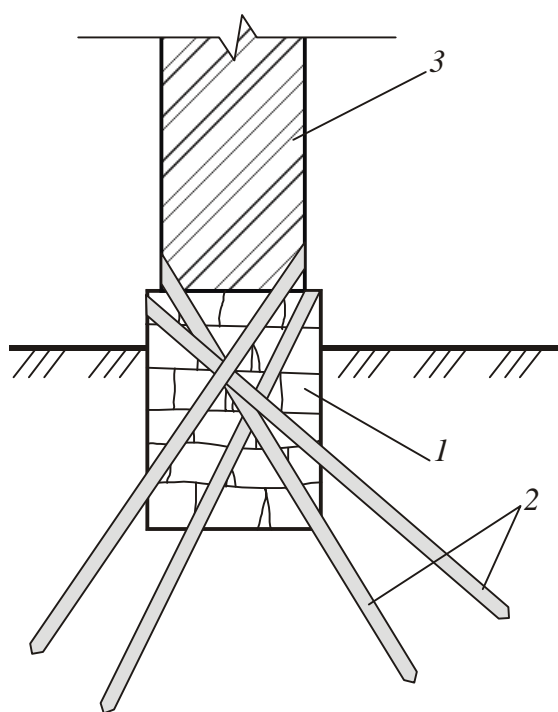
Усиление фундаментов буроинъекционными сваями:
